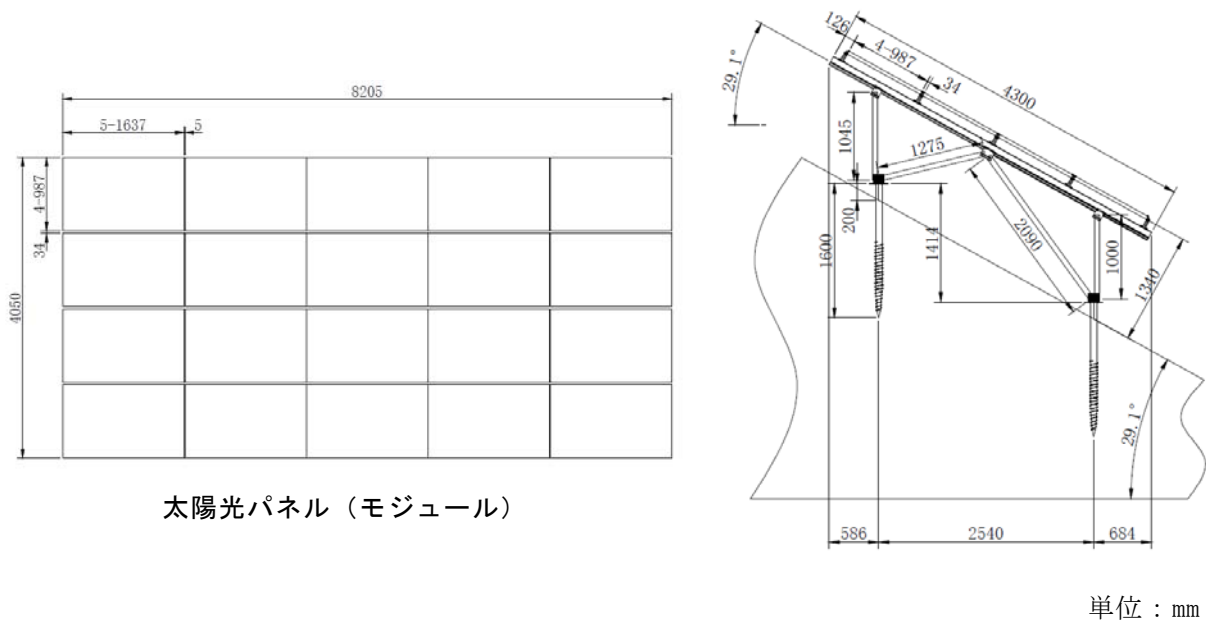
太陽光パネル平面図及び架台断面図（例）
